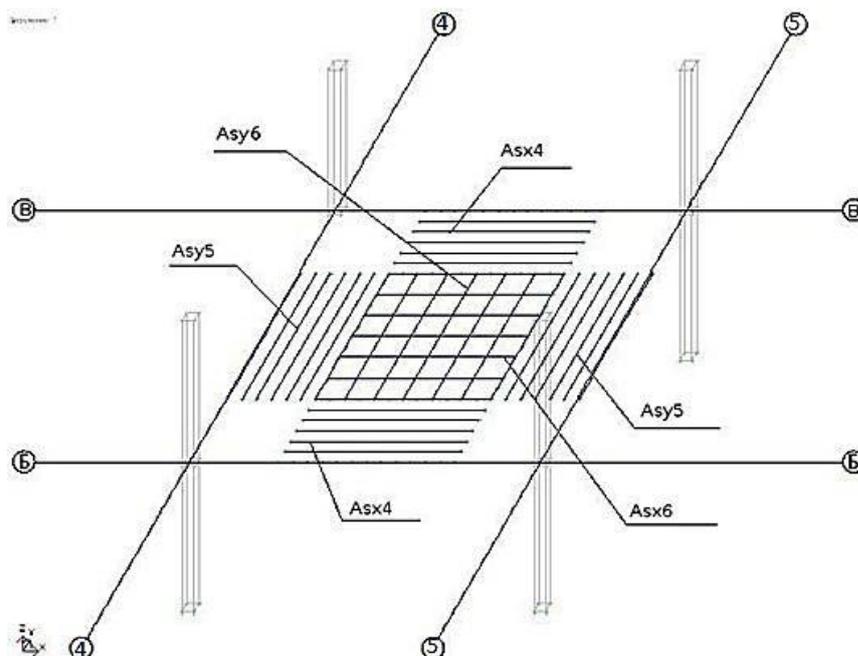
Схема нижнего армирования плиты перекрытия
